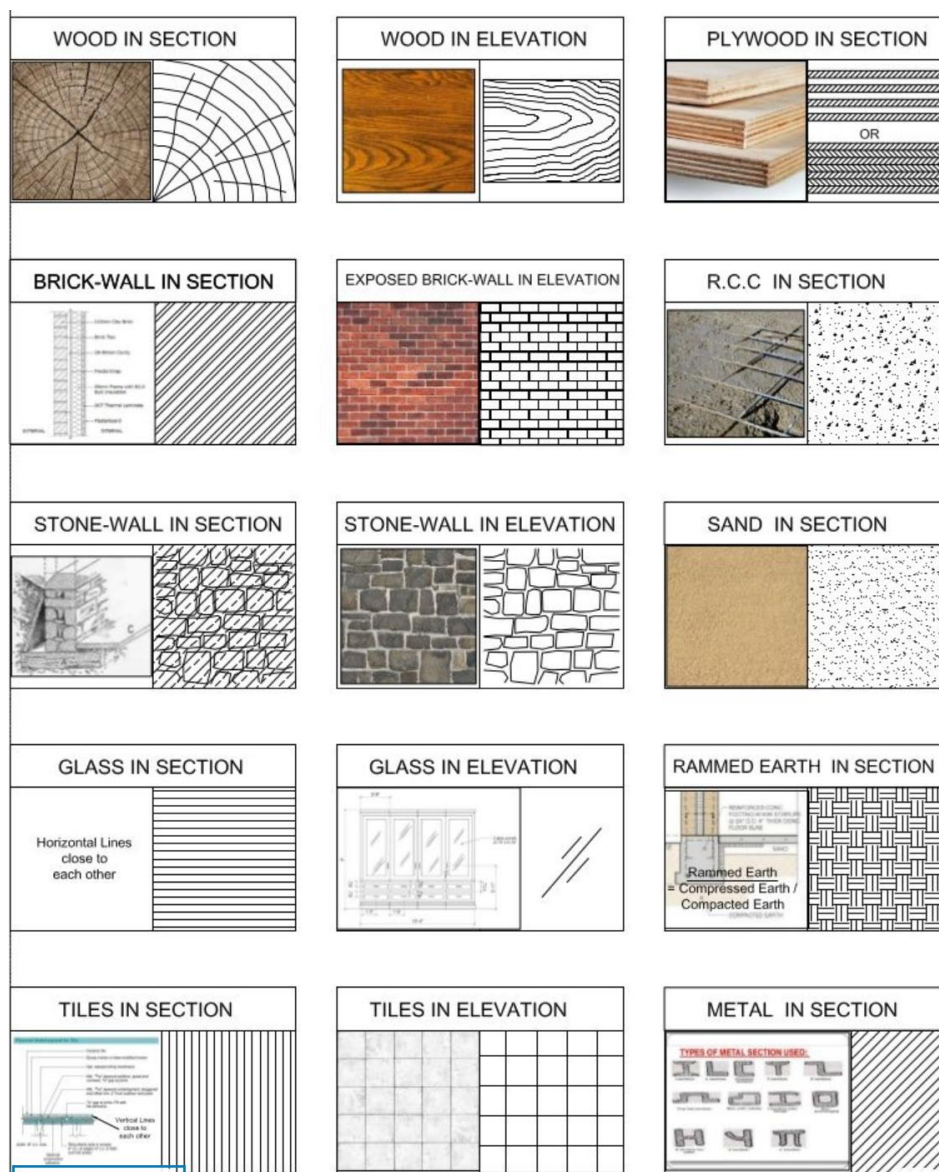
Simbología para: Madera en corte y en alzado; Laminado en corte; Ladrillo en corte y alzado; Concreto en corte; Ladrillo en corte y alzado; Arena en corte, Vidrio en corte y alzado; tierra compactada en corte; loseta en corte y alzado y Metal en corte respectivamente.
